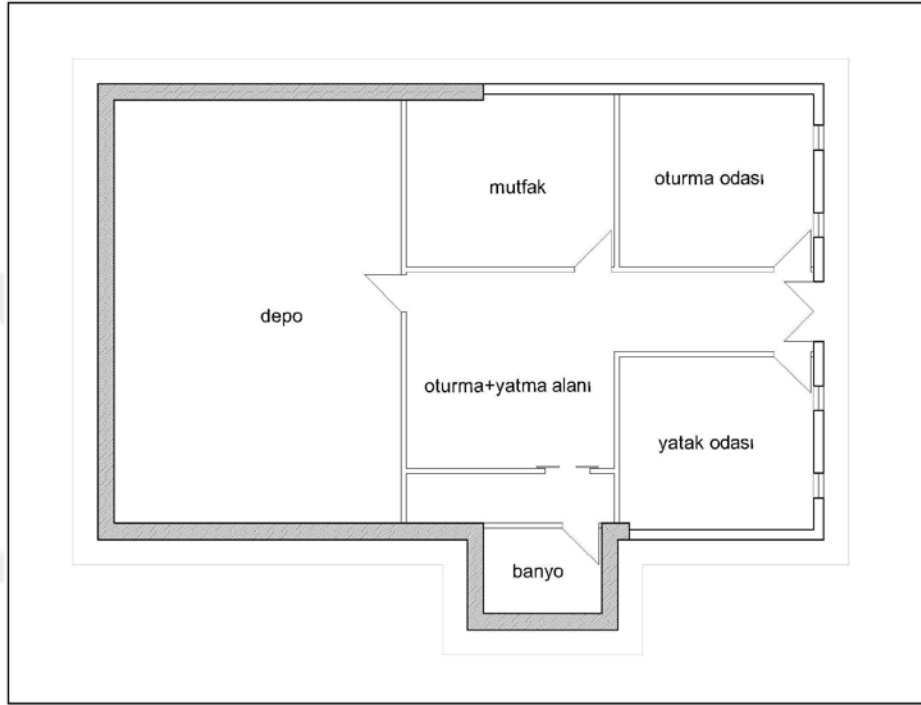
Honderoğlu Mustafa Evi vaziyet planı.
